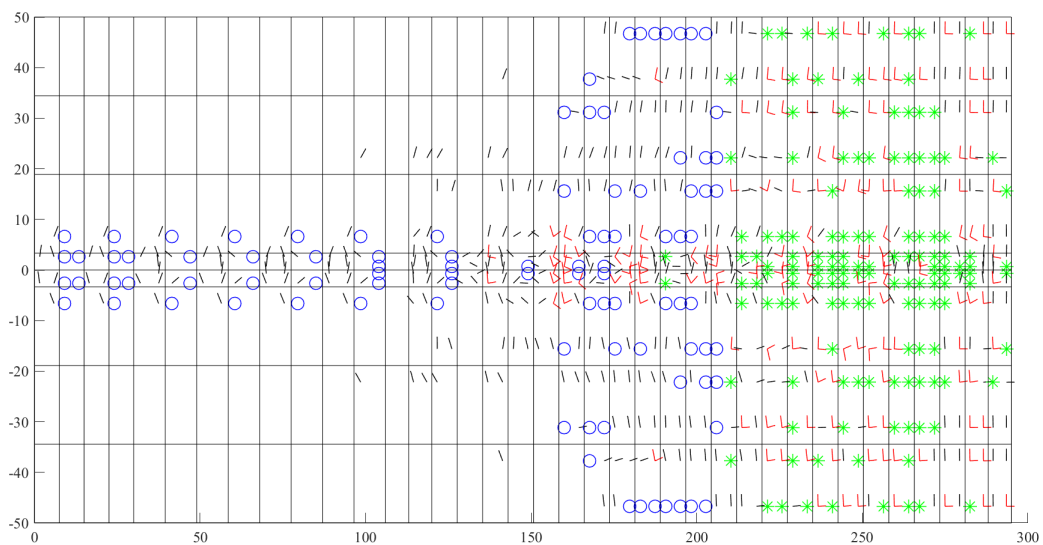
Padrão de fissuração na camada inferior da laje de concreto (viga B1 fluxo), (ELU)
